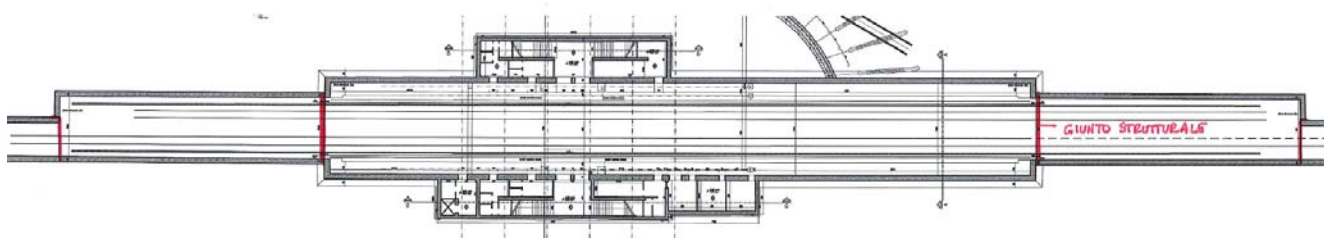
Pianta dell'interrato: giunti strutturali in evidenza
